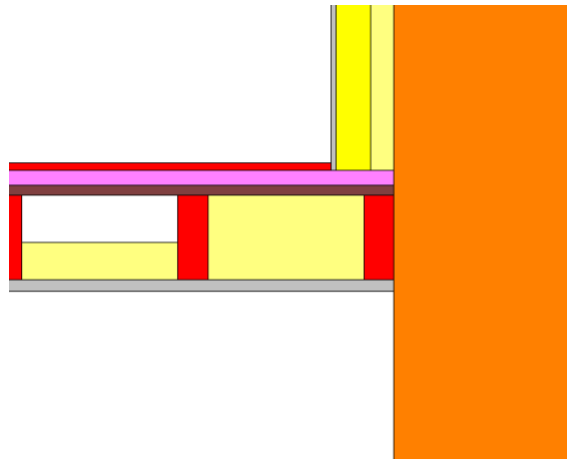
illustration (en coupe) de la solution 2 proposée pour le nœud constructif formé par l'intersection du mur isolé par l'intérieur et du plancher du R+1
